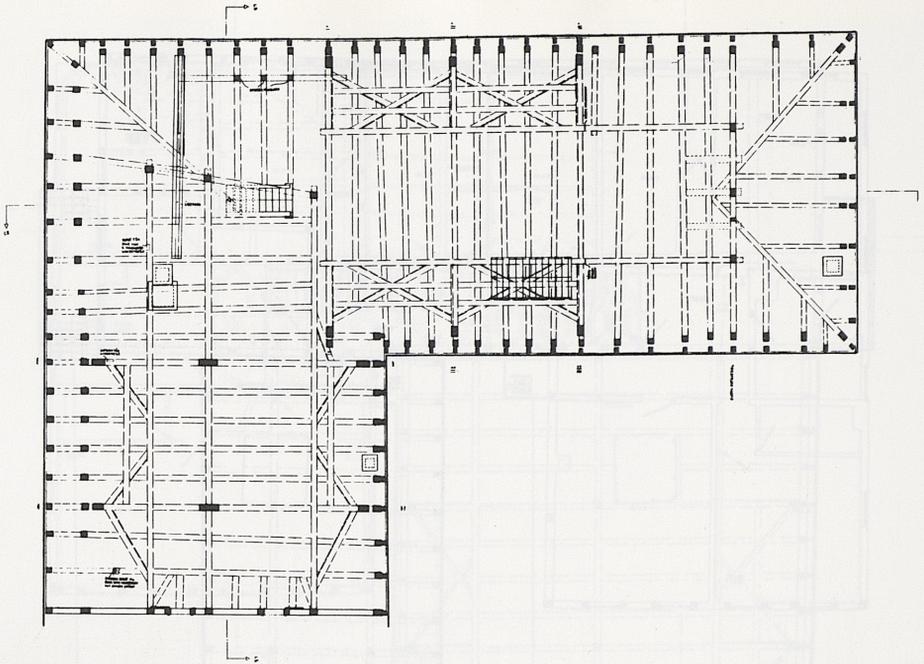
Schnait, Unteres Schloß, Silcherstraße 10. Grundriß des Dachgeschosses, Maßstab 1:200.
